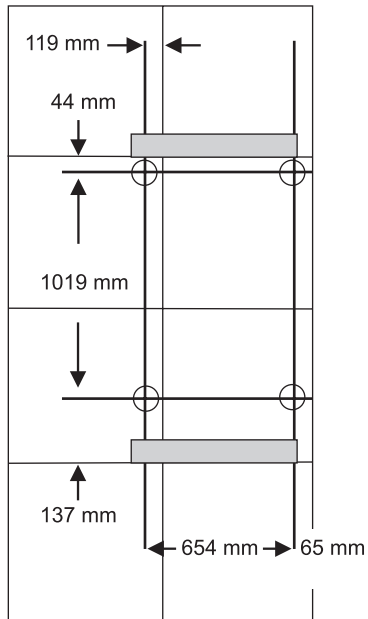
Positionnement des découpes de câble pour dalles de plancher de 600 mm
